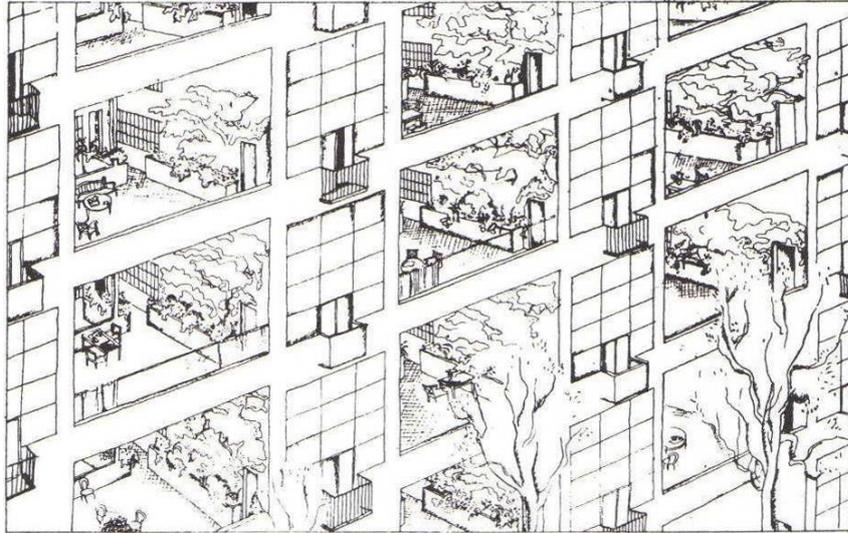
Perspectiva da fachada dos loteamentos fechados.
